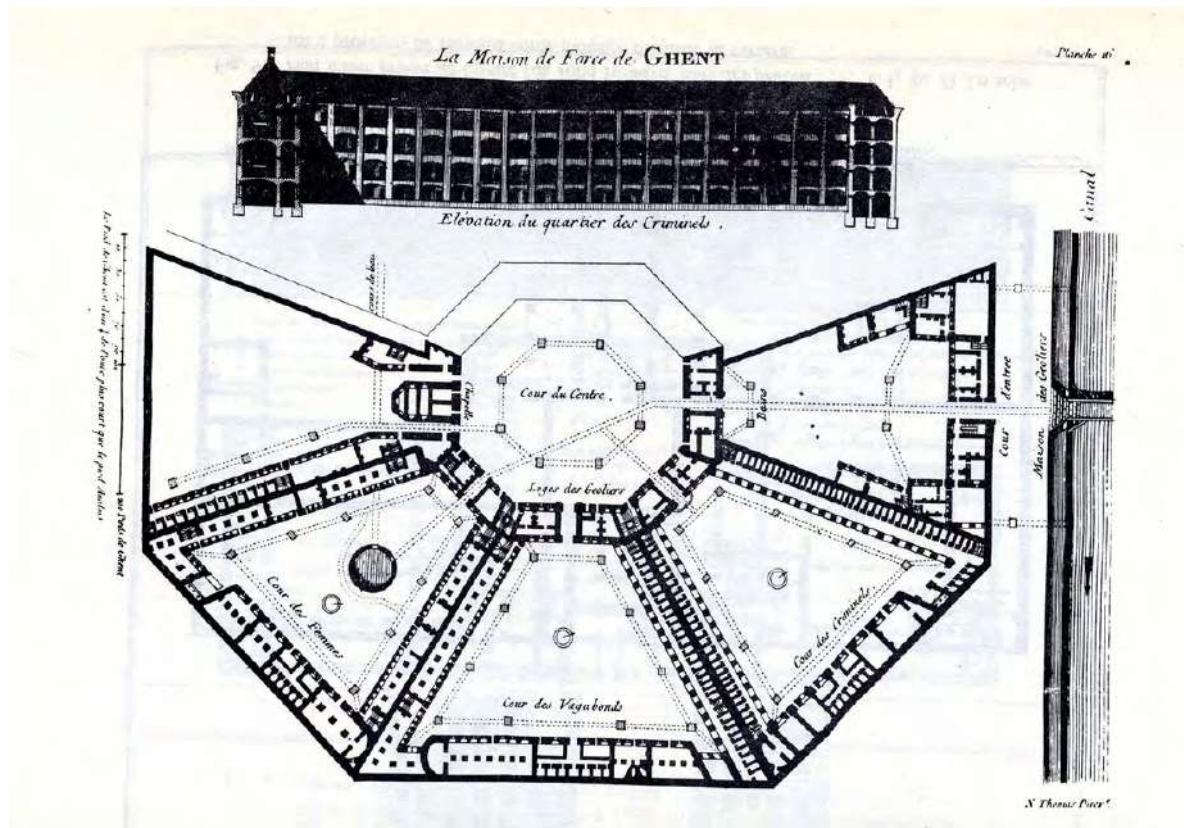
Planimetria e prospetti della Maison de Force de Ghent (Gand) (da HOWARD 1778, in COMOLI MANDRACCI 1974, p. 36).
